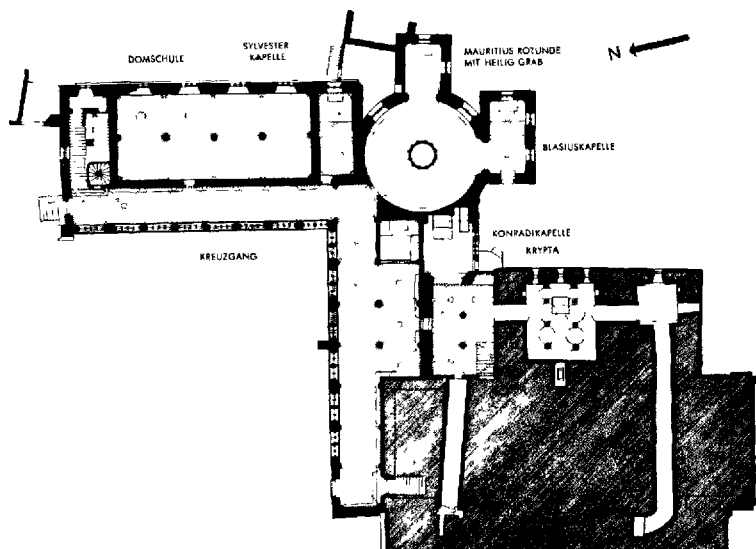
Konstanz, Nebenbauten des Münsters, Grundriß des Untergeschosses (Aufnahme: Staatl. Hochbauamt Konstanz).
